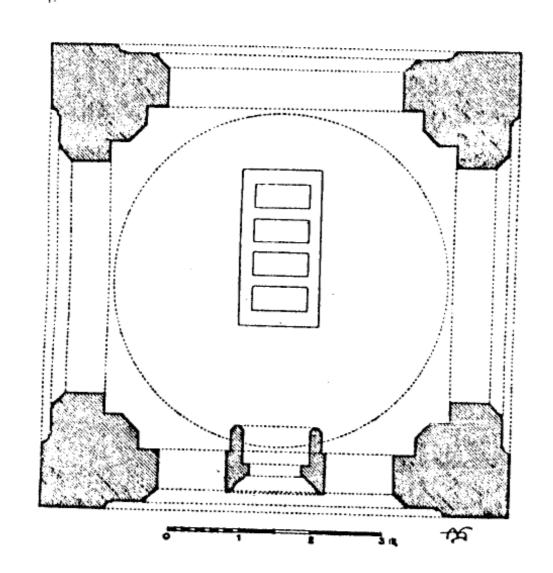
مسقط أُفقى لقبة الكومسى (مقياس الرسم ١/٥٠)
